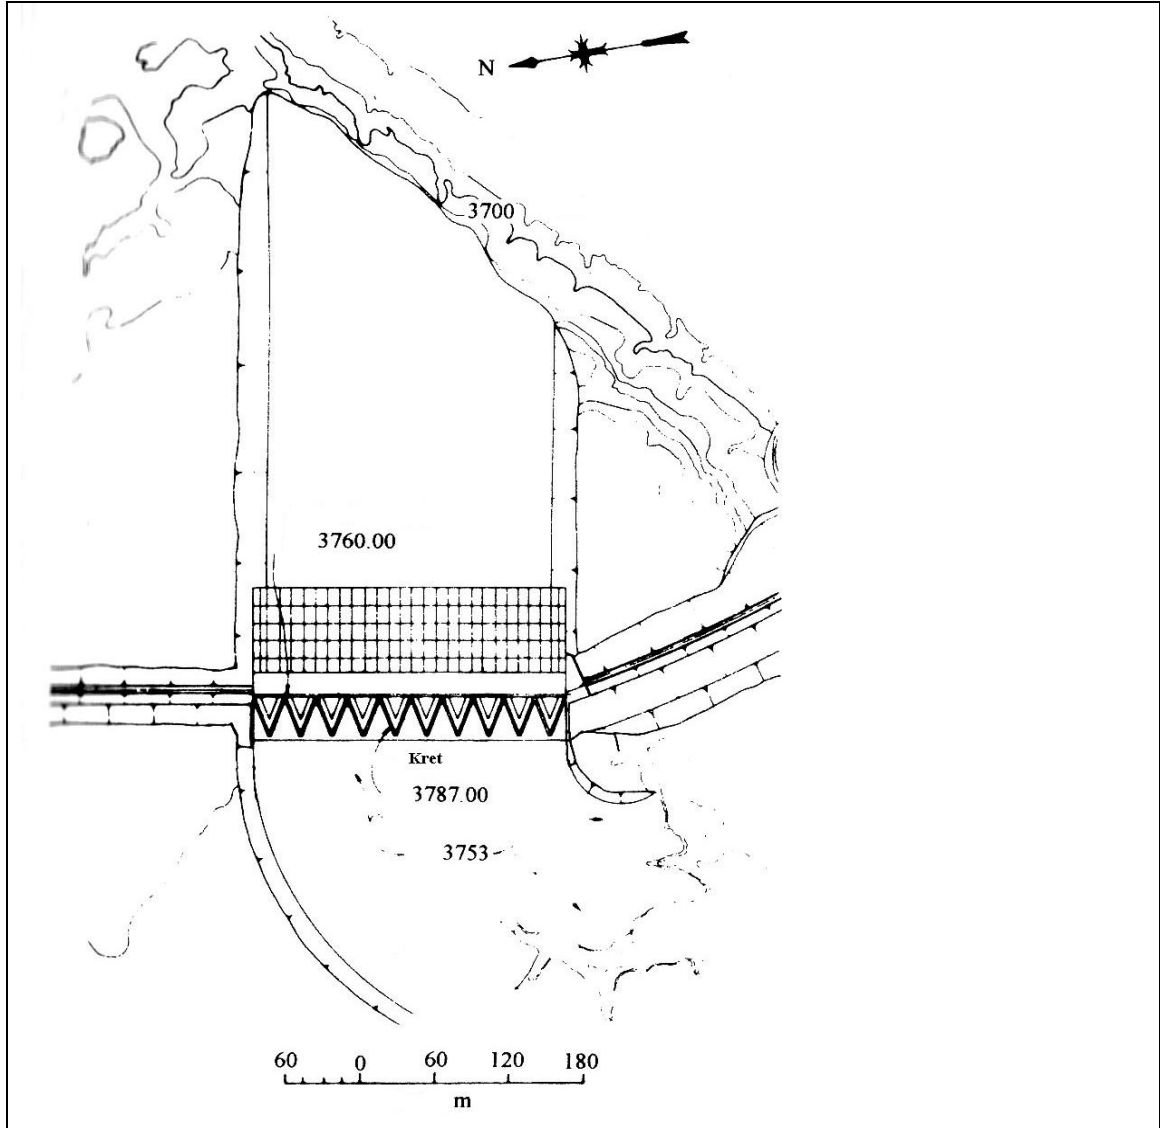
Hyrum Barajı Labirent Dolusvağı Yerleşim Planı ve Kesiti [6]
